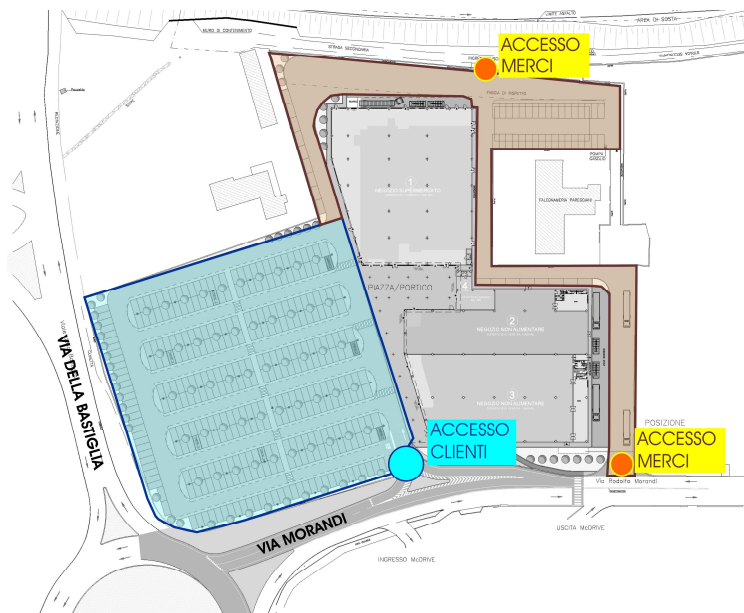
Planivolumetrico intervento – Localizzazione degli accessi
